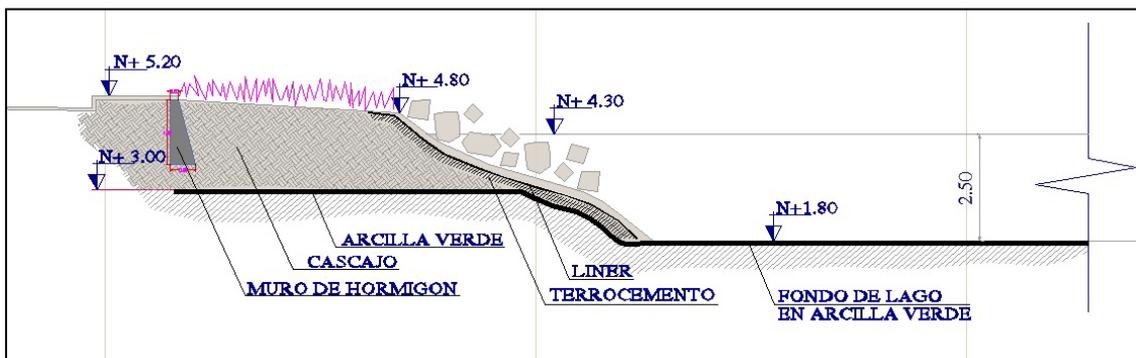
ESTRUCTURA TRASVERSAL DEL LAGO (1)
